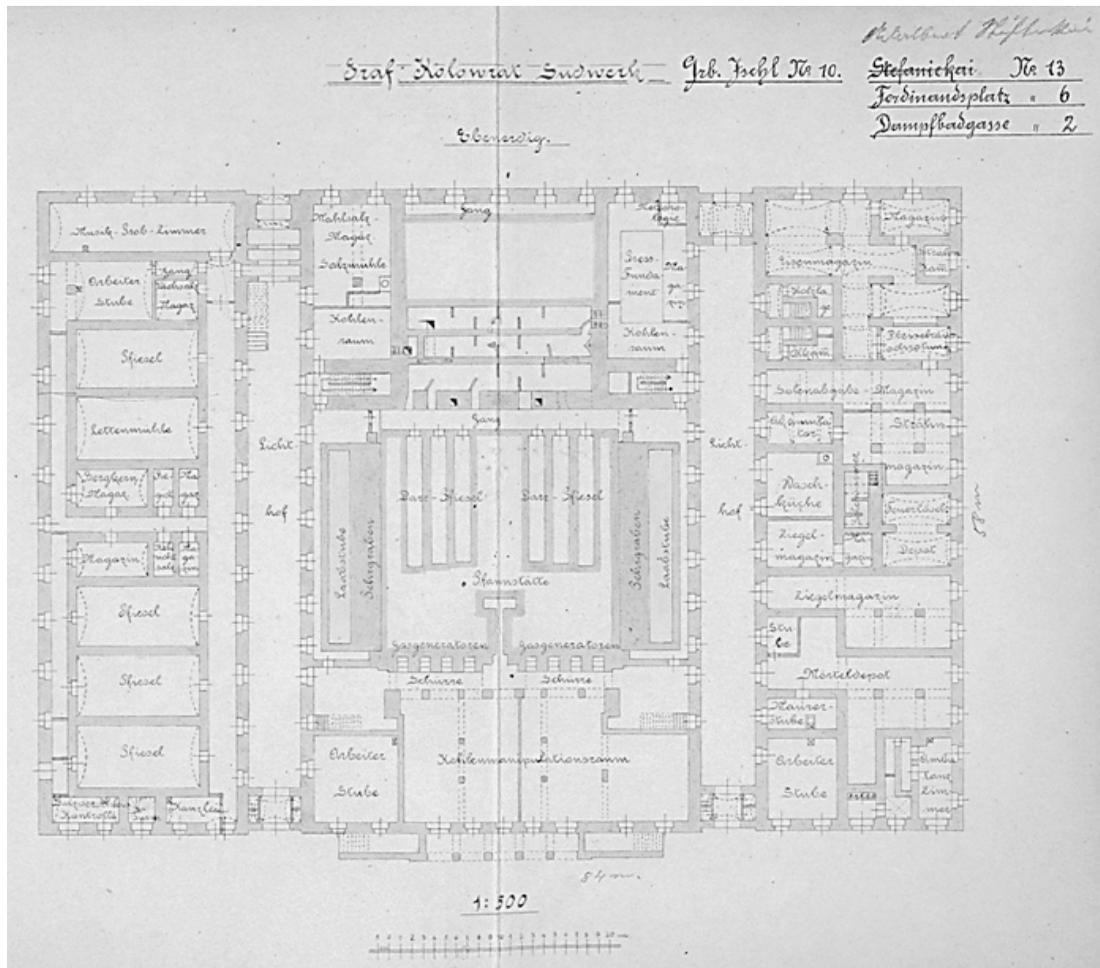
Graf-Kolowrat-Sudhaus, Grundriss Erdgeschoss, 1847
